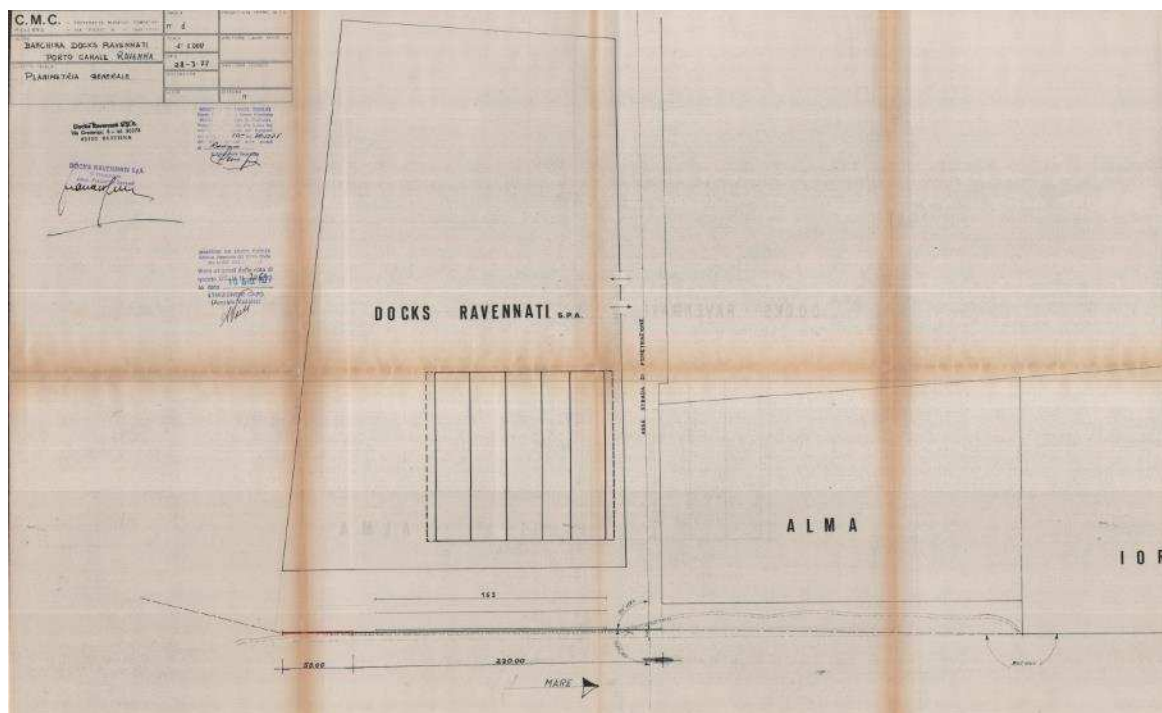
Planimetria generale del progetto di realizzazione del banchinamento del 1977
